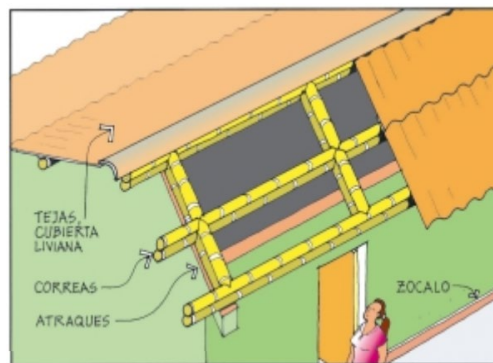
Elementos de la cubierta para construcciones con bambú
